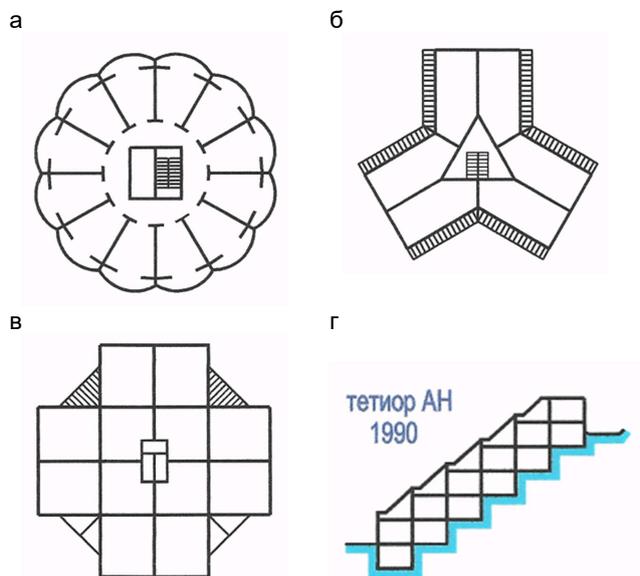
Примеры объемно-планировочных решений зданий:
